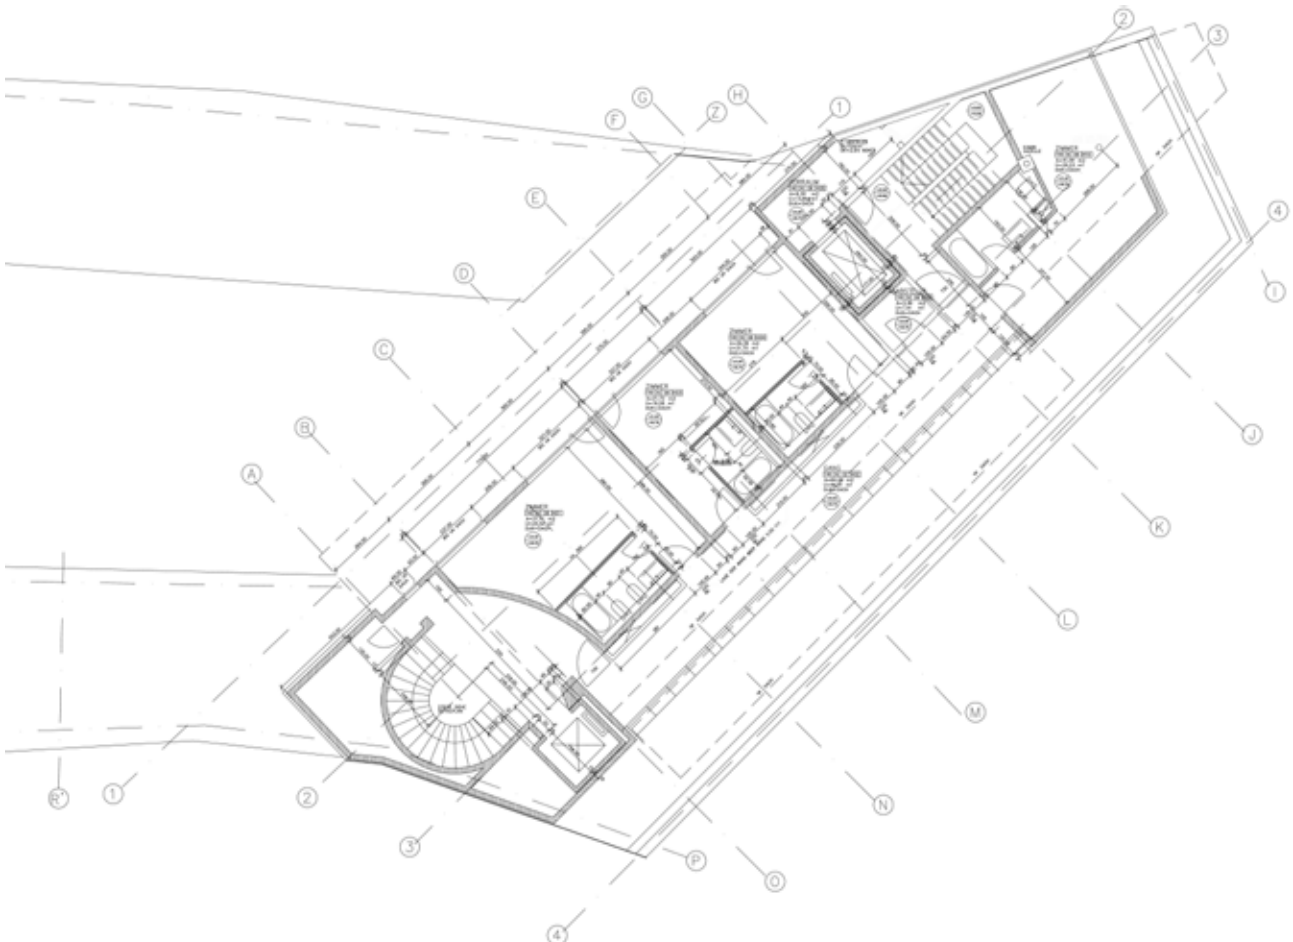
\_ Grundriss © Peter Lorenz Ateliers
